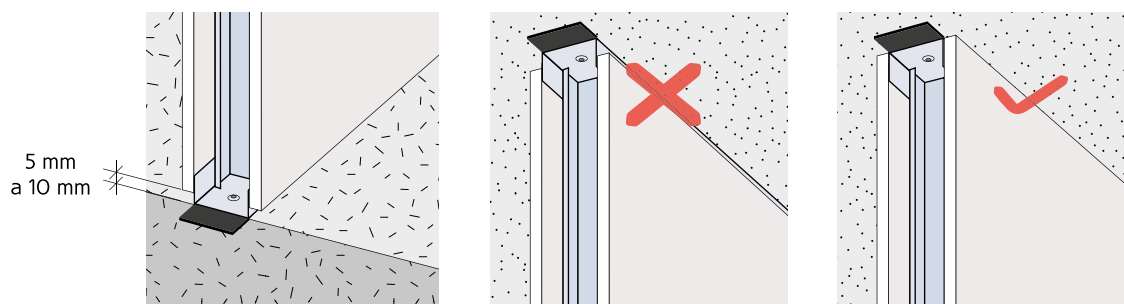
Aplicação das placas encostadas ao teto e afastadas 10 mm do pavimento.
